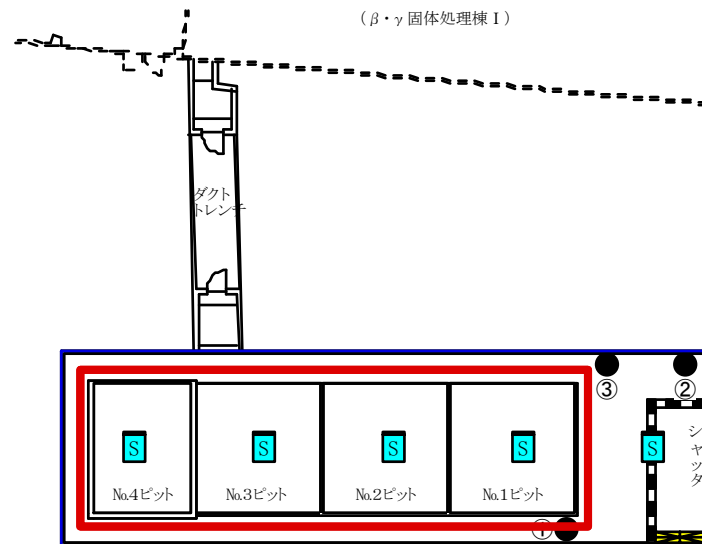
1 9 廃液貯留施設 I (廃棄物管理施設用廃液貯槽) 平面図及び可燃物配置図
